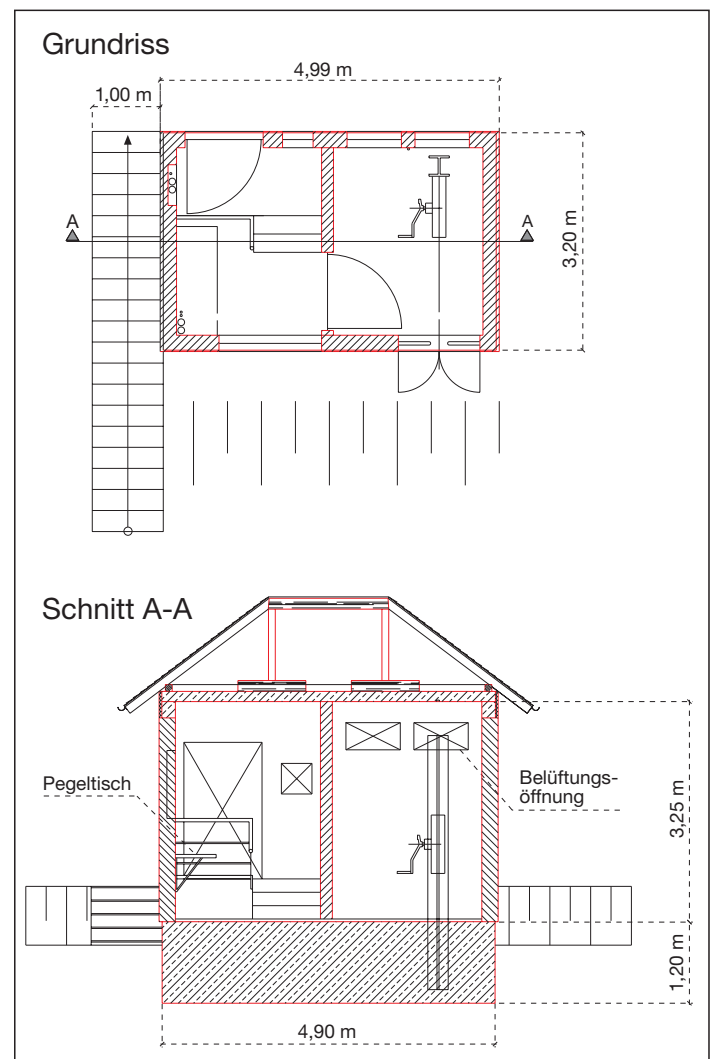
Das kombinierte Pegel-Windenhaus: Grundriss und Schnitt
